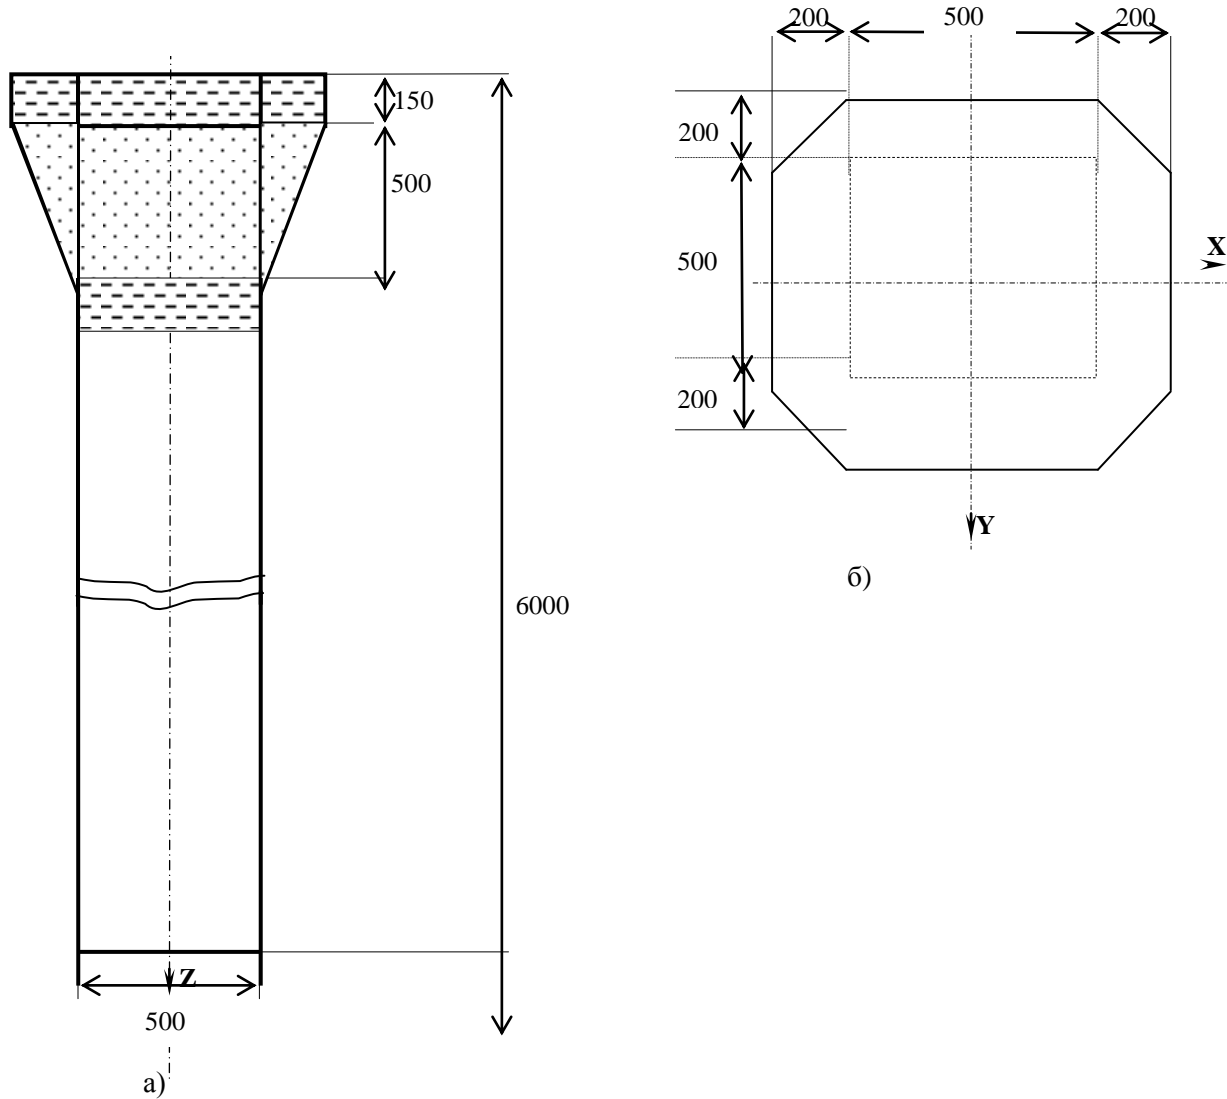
Расчетная схема колонны К-1 (а - вид сбоку; б - вид сверху)
